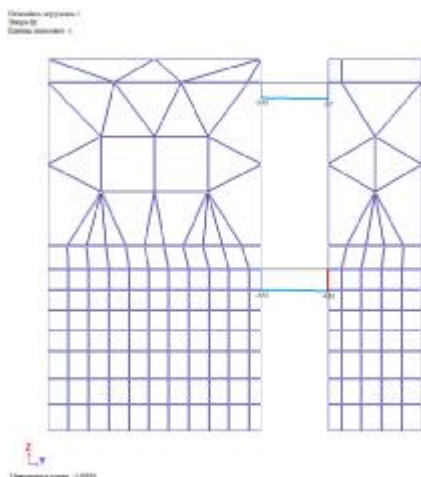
Фрагмент конструкций 2-го и 3-го этажей. Эпюры поперечных сил в перемычках после введения односторонних связей
